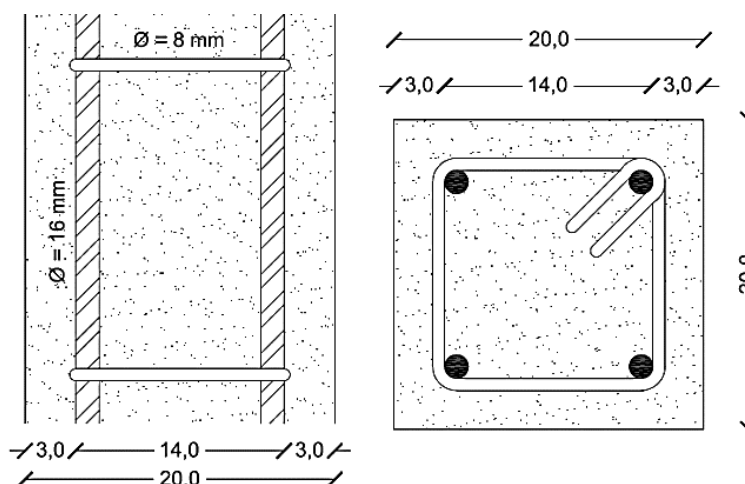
Representação esquemática das seções transversal e longitudinal dos pilares P1 e P2 (medindo 20x20 cm de sessão transversal), cobrimento de 3,0 cm e as armaduras principais com bitola de 16 mm e estribos com bitola de 8 mm.
